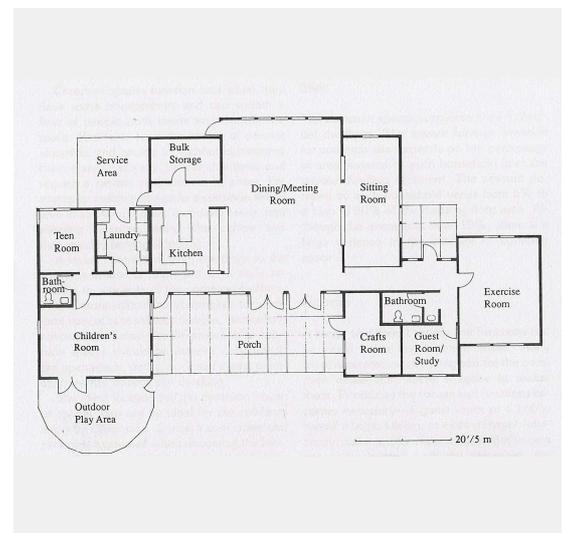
Planimetria del piano terra della Common house di Muir Commons.
